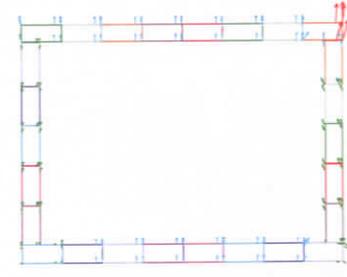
Cálculo com paredes e lajes - Cota 15m
